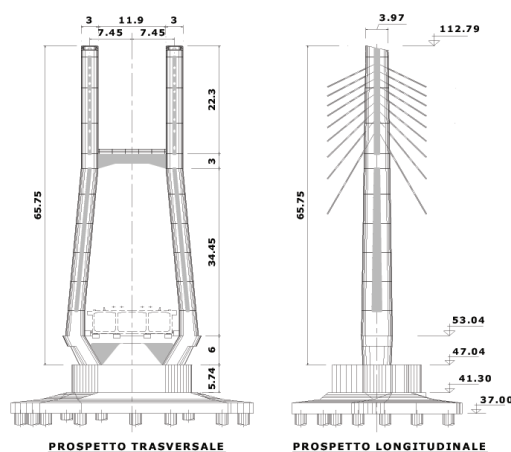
Antenne del ponte strallato sul Po. Towers of the cable-stayed bridge on the river Po.
